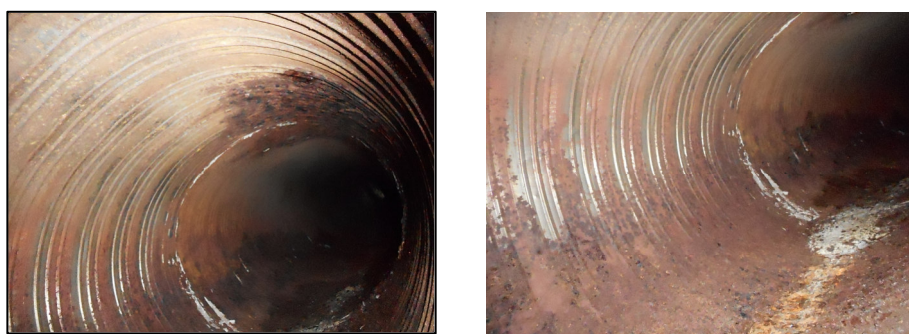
Vista dall'interno di un tubo corrugato di alleggerimento
